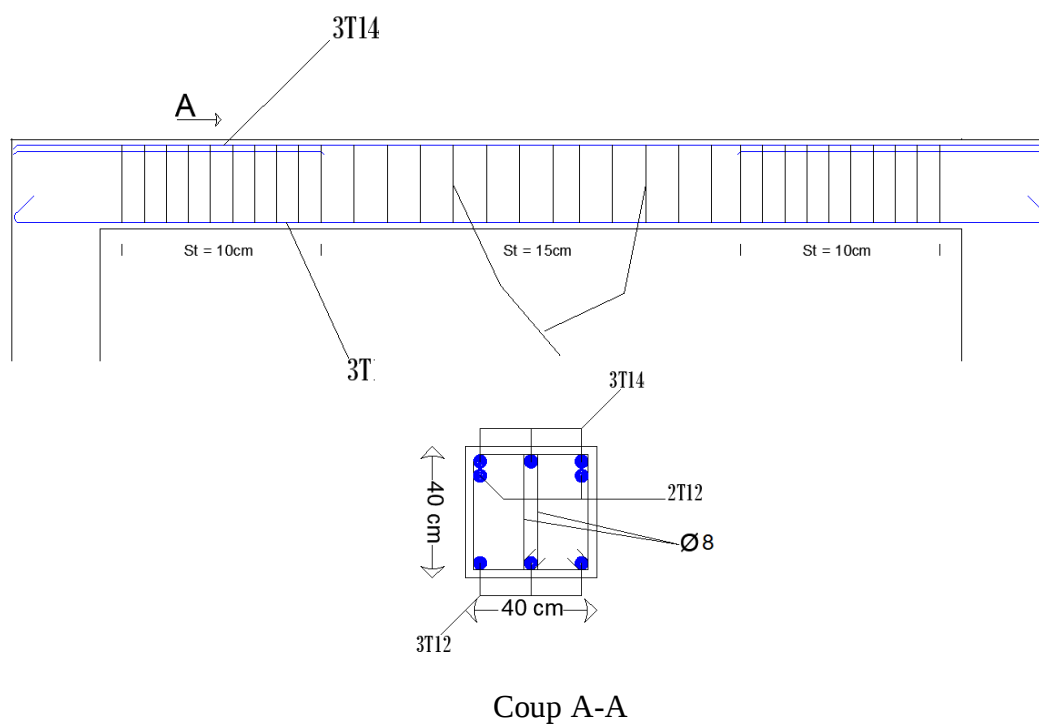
Schéma de ferrailage des poutres principales (Terrasse).
